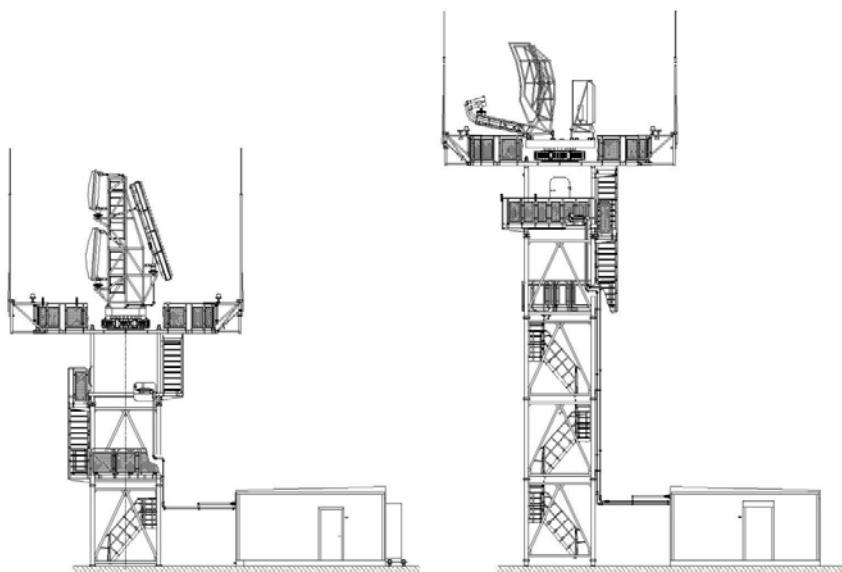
Общий вид компоновки РЛС на основе корпусов – модулей типовой системы несущих конструкций
